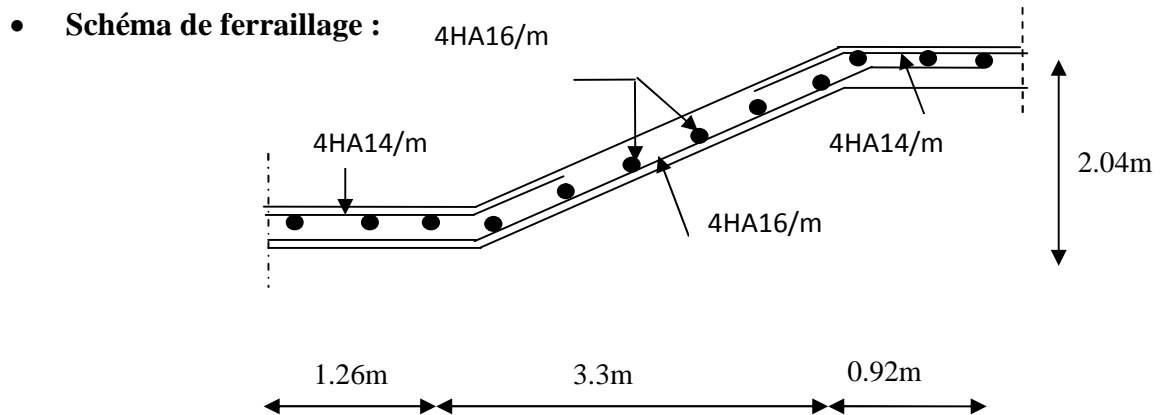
Schéma de ferrailage de la 1^{ère} volée du 1^{er} étage.
